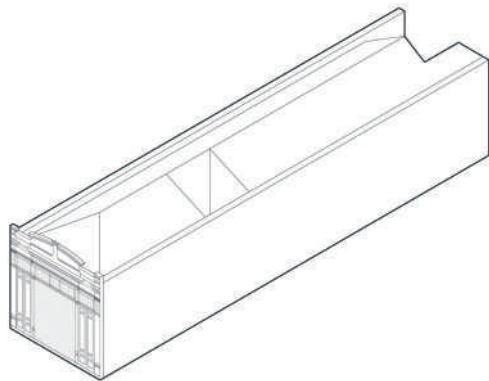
1 construção de armazém e aprovação na prefeitura.
